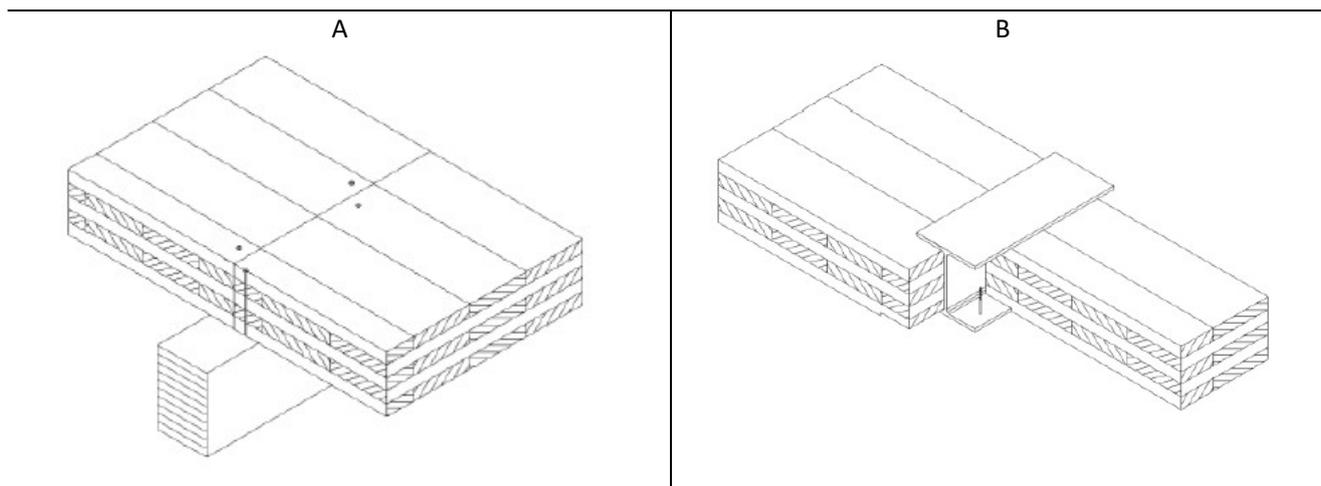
Collegamento d'angolo tra solaio e travi principali. A con trave ricalata in legno lamellare. B nello spessore del solaio con trave in acciaio
